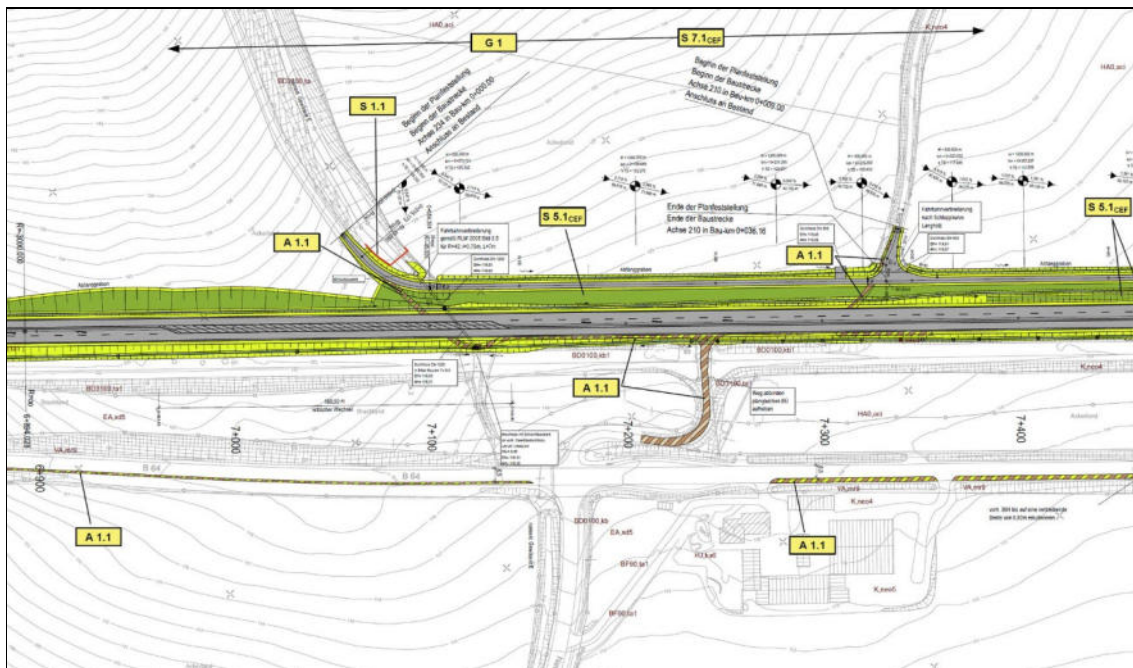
Ausschnitt aus dem Maßnahmenlageplan des LBP zu F 2.
